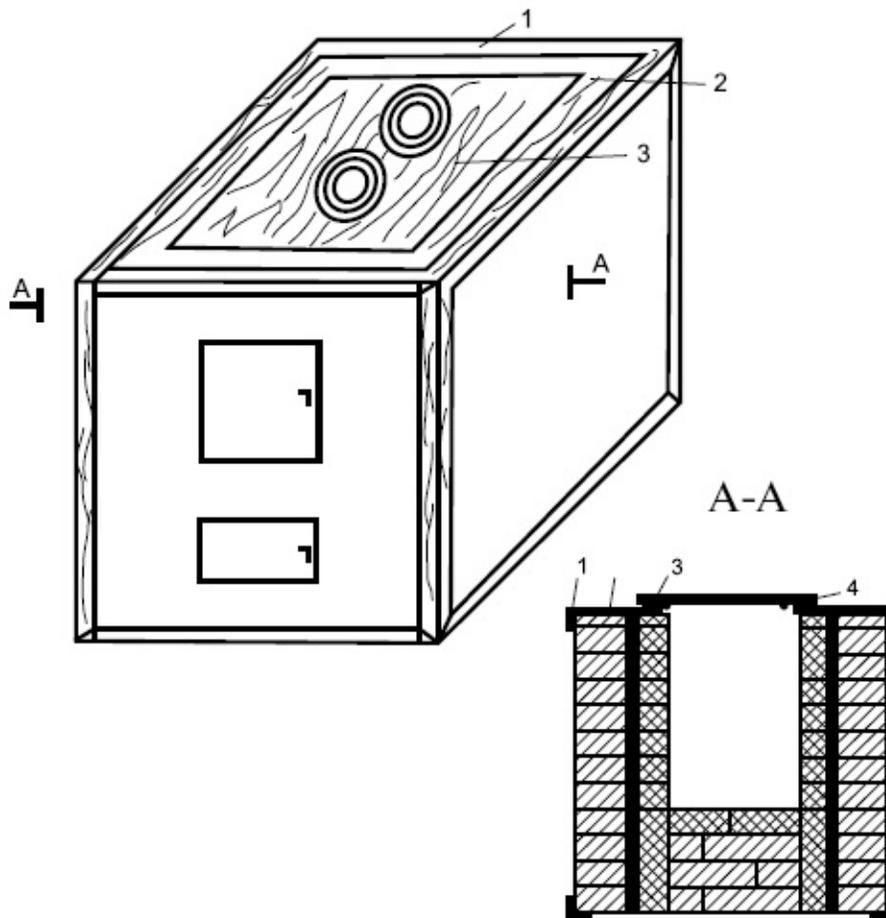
Топливники печей в каркасе из стального уголка: 1 – стальной уголок; 2 – стальная пластина; 3 – чугунная плита; 4 – уплотнитель (асбестовый шнур либо шнур из стеклоткани с каолиновой ватой) Способы кладки перемычек топочных дверок, духовок чугунных либо стальных
